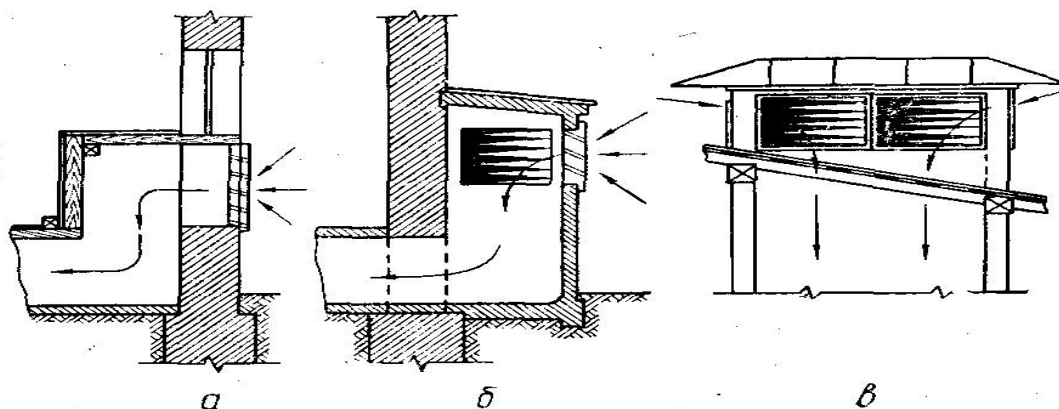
Способы забора наружного воздуха (Учебник «Пожарная безопасность в строительстве» Часть 1 пожарная безопасность систем отопления и вентиляции) а – через отверстие в стене; б – с помощью приставной шахты; в – через шахту, выведенную над крышей здания
